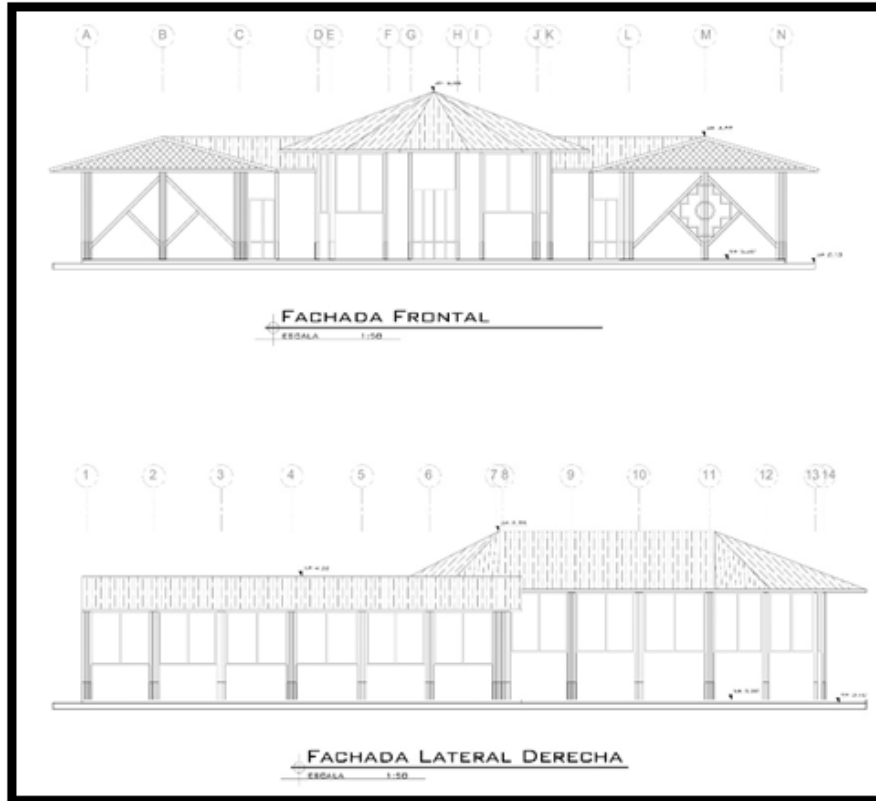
Fachada Frontal y Fachada Lateral Derecha
